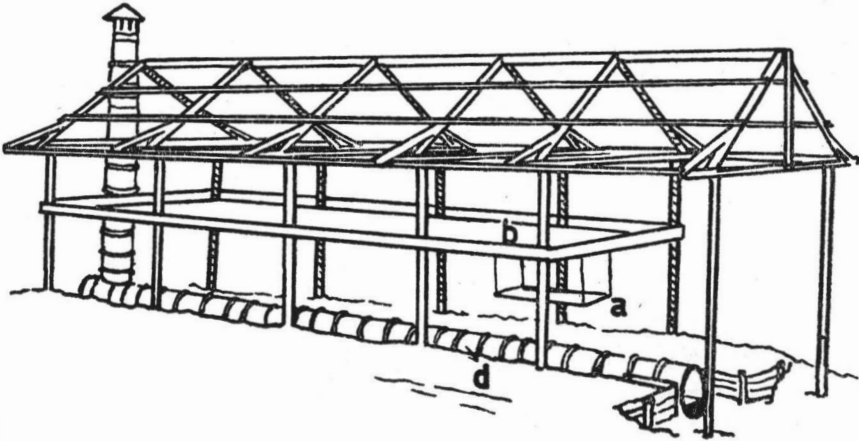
Séchoir « Samoa », vue d'ensemble.
